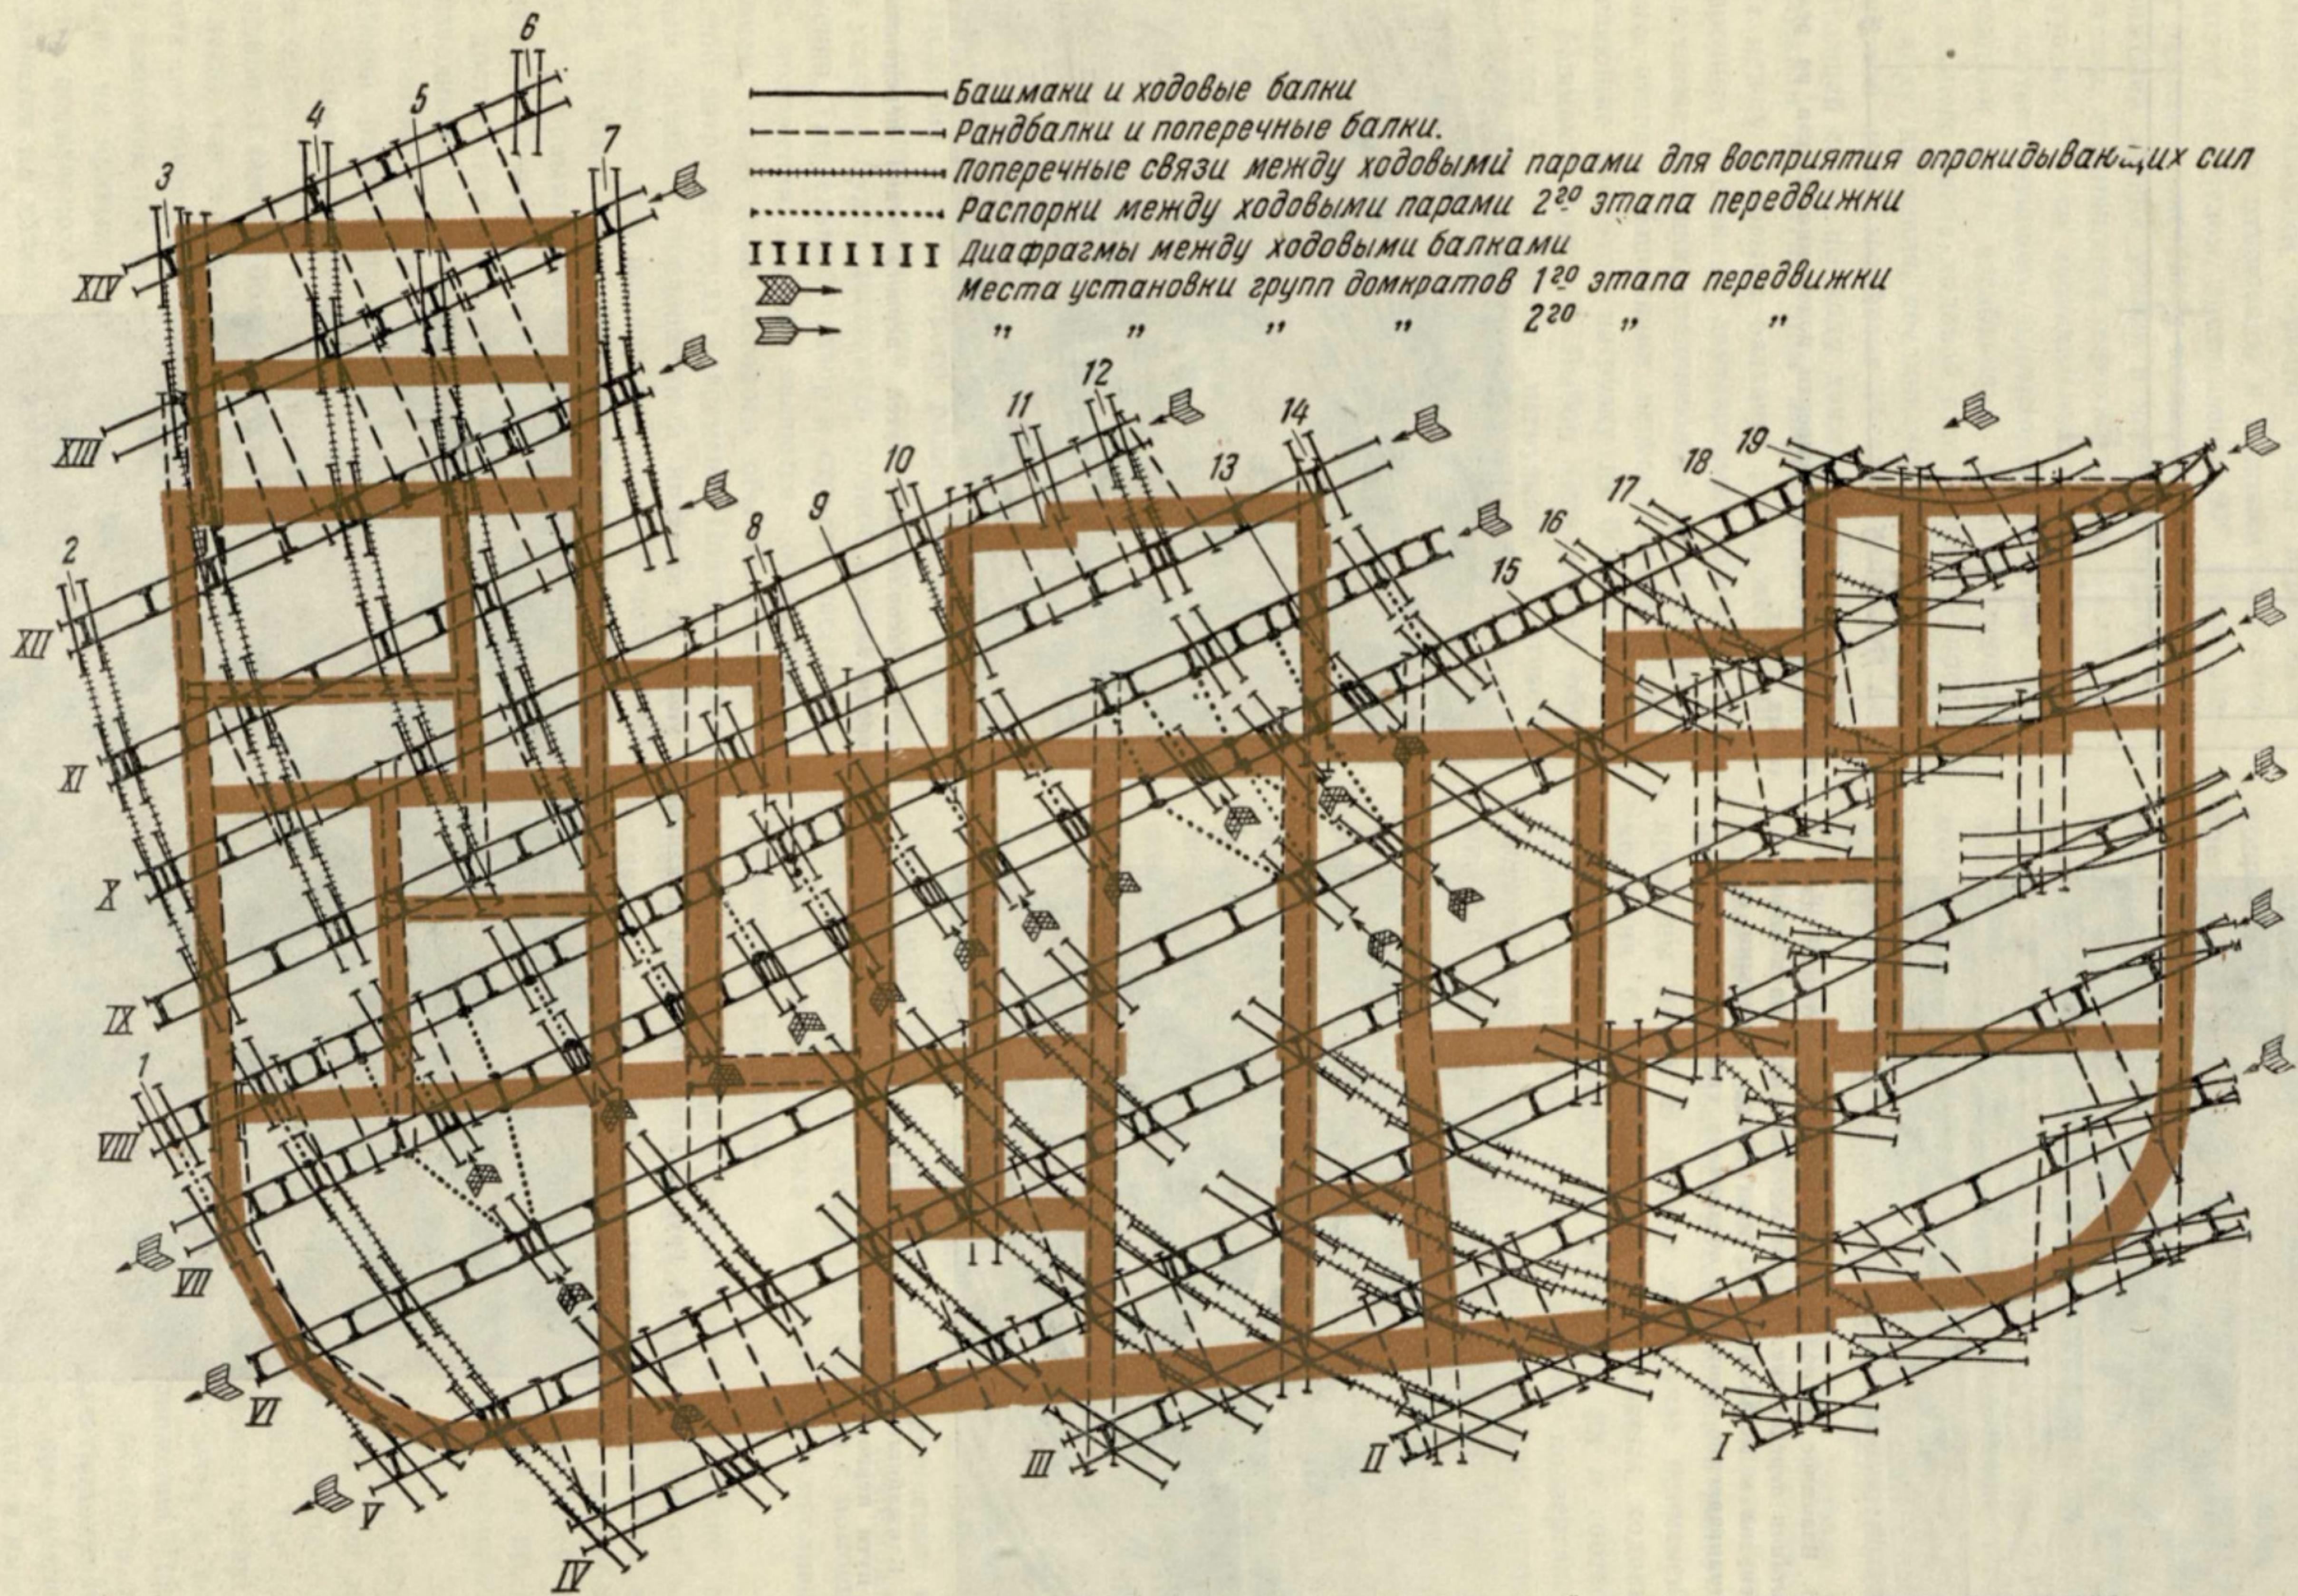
План расположения рандбалок, ходовых конструкций, толкающего оборудования и осей рельсовых путей первого и второго этапов передвижки.
